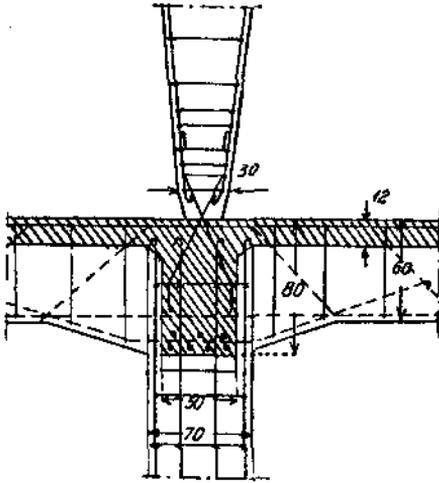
Схема устройства шарнира в железобетонной стойке.
